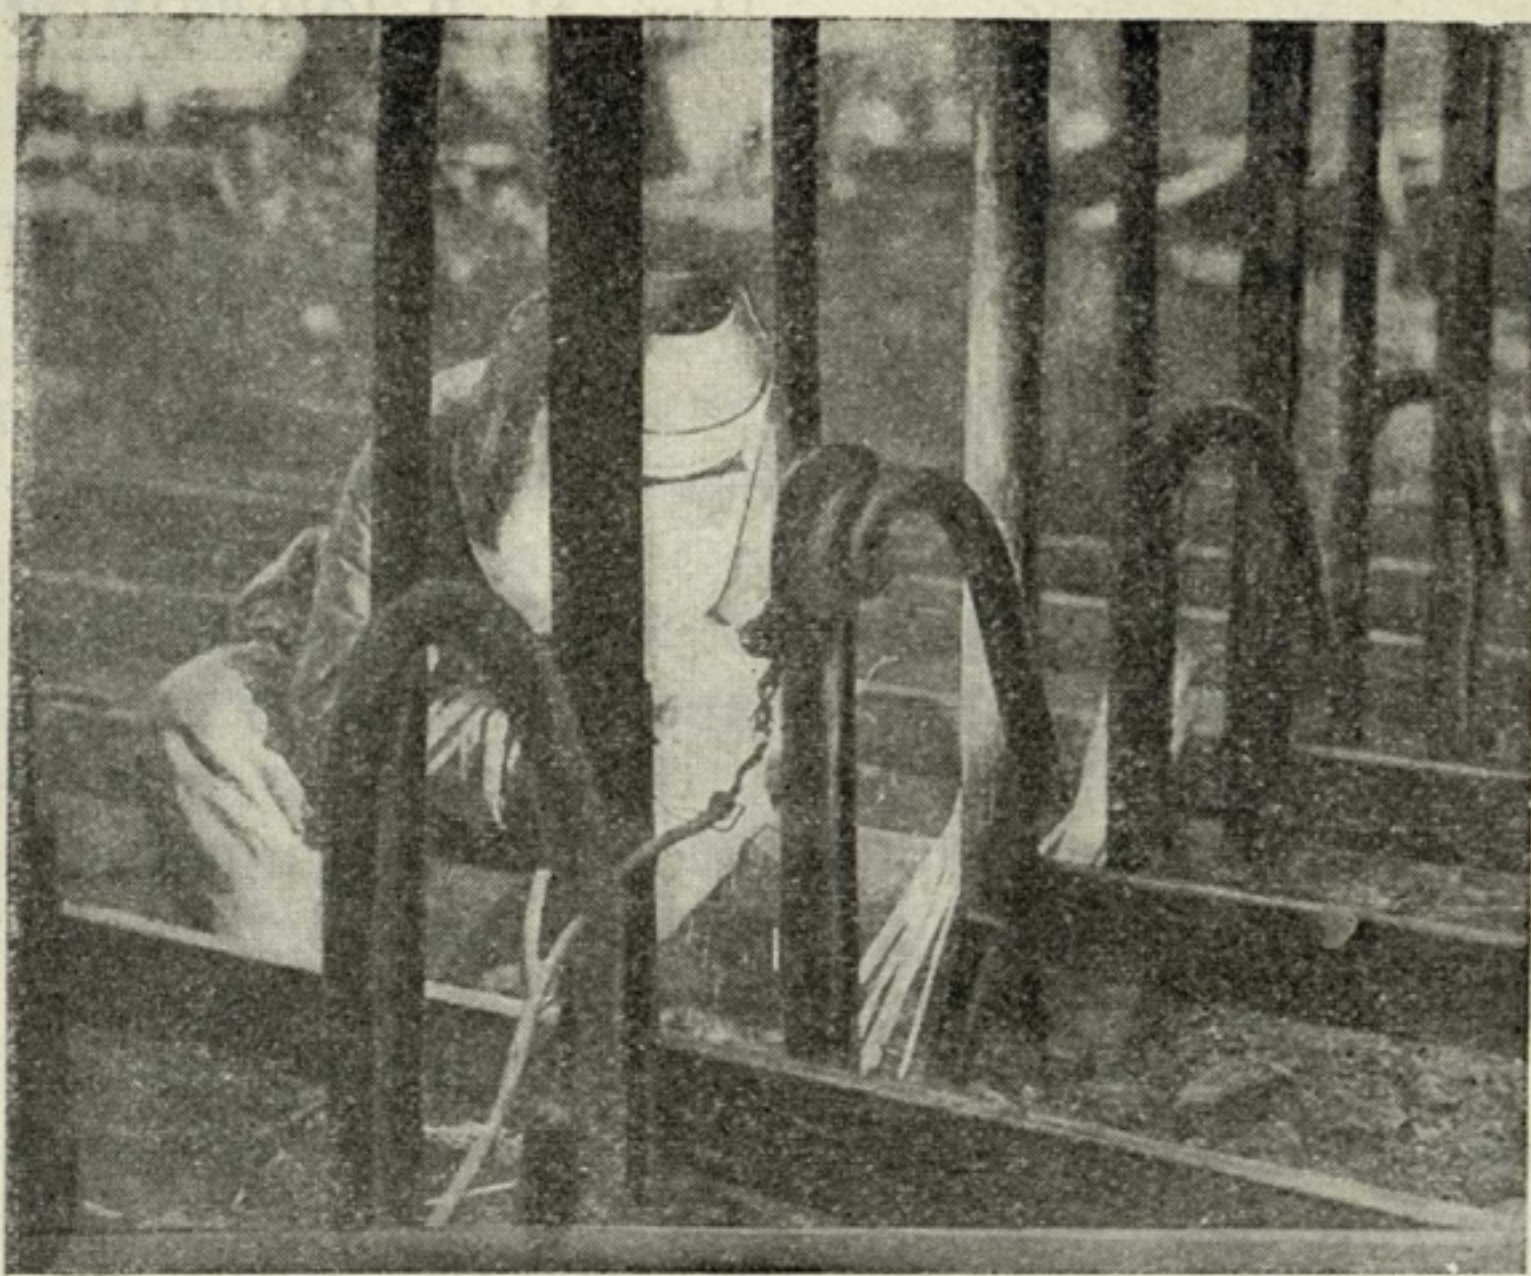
Сварка арматуры железобетонной кольцевой балки, опоясывающей «главные фундаменты».
